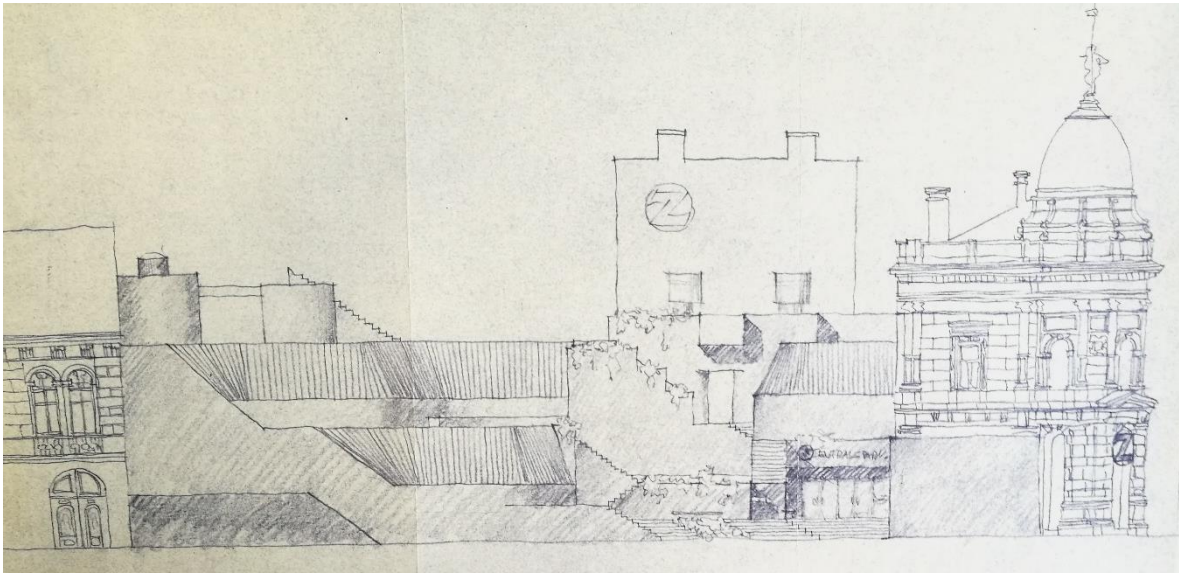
Plan Nr. 8, Ansicht Schwaigergasse, Hans Hollein, 1966
